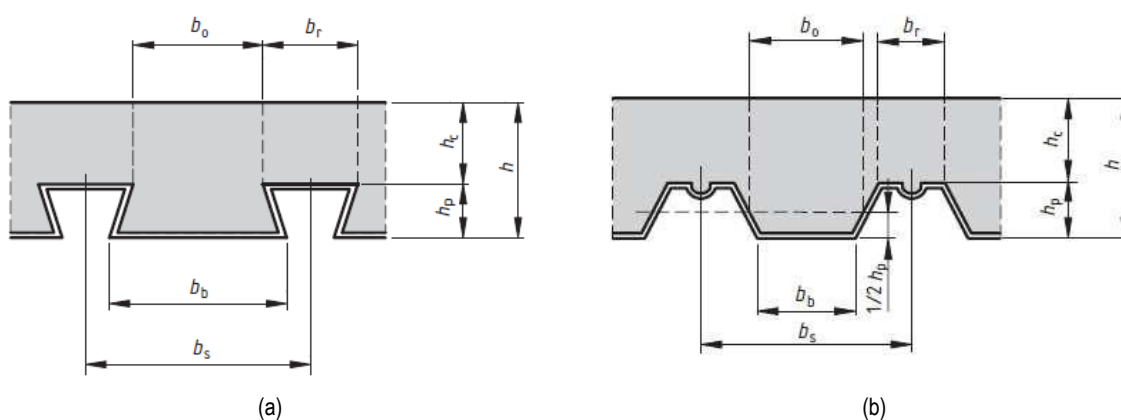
Dimensões das chapas perfiladas e das lajes (EC4-1-1): (a) perfil reentrante; (b) perfil trapezoidal
